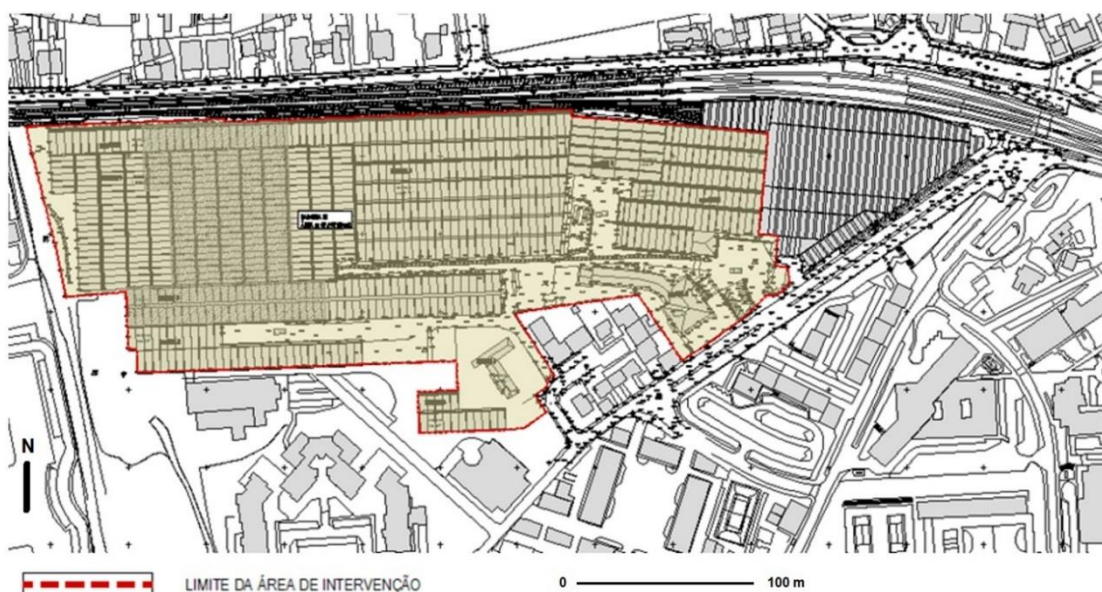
Extrato da planta de cadastro do projeto “Fundição de Oeiras Village”
